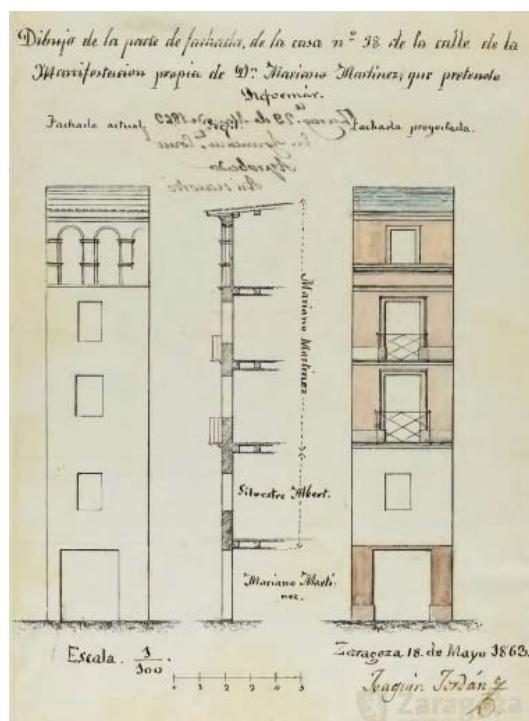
Reforma proyectada en la fachada del inmueble núm. 98 de la calle de la Manifestación, Zaragoza, por el arquitecto Joaquín Jordán, 18 de mayo de 1863 (AMZ).
